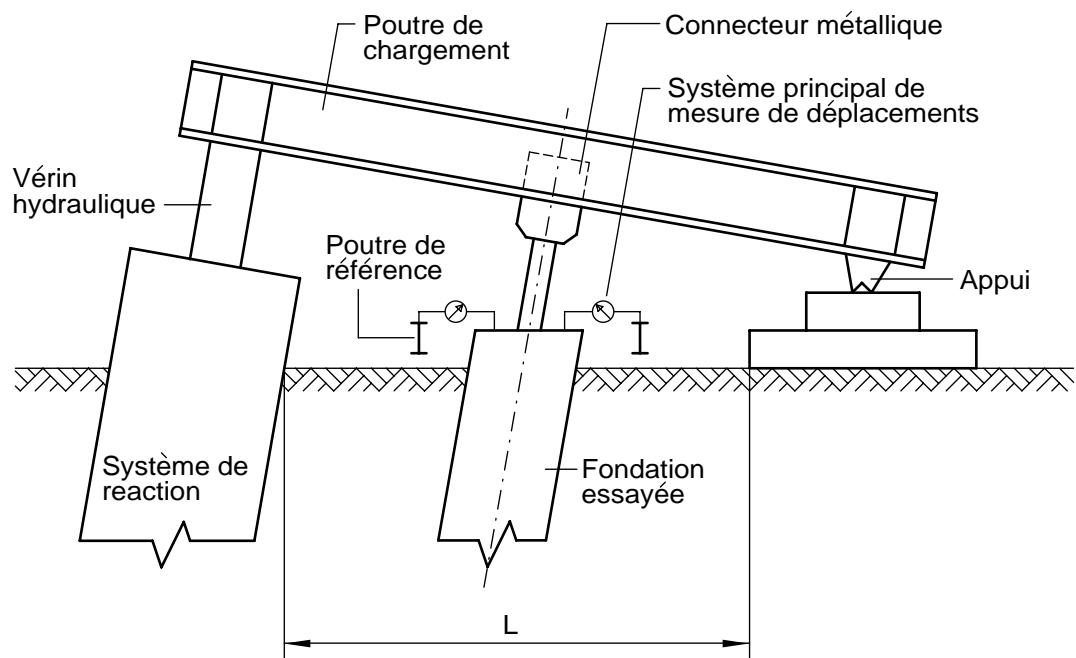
Application de la charge par vérin hydraulique et poutre pivot
